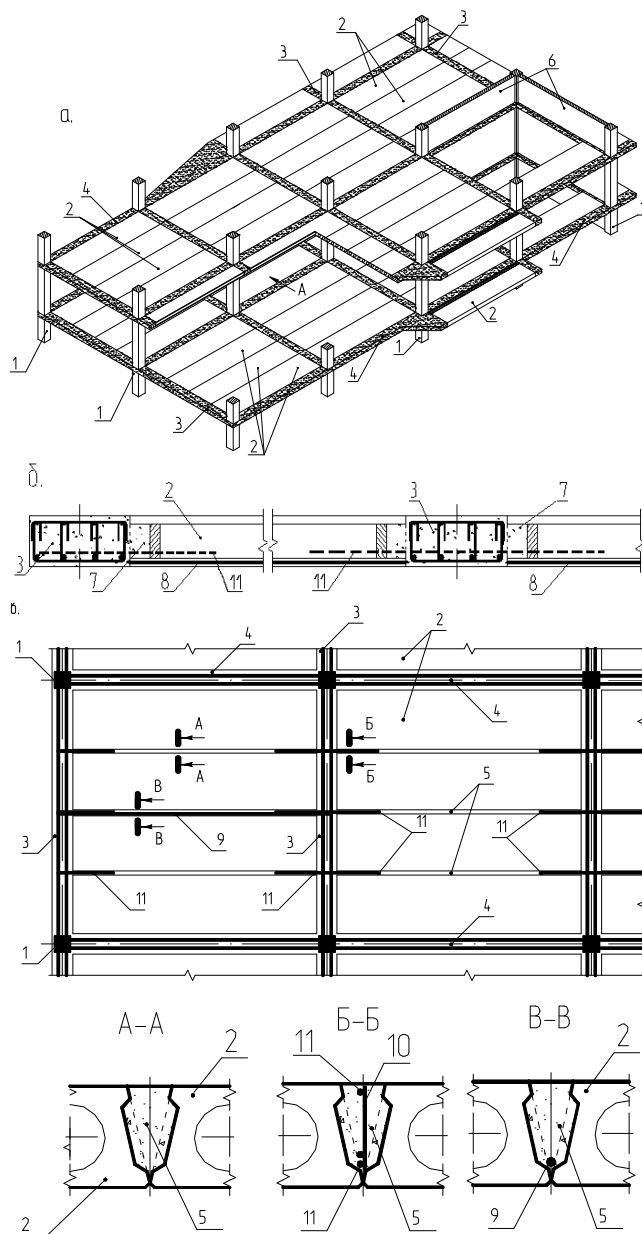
Конструкция каркаса. а – общий вид каркаса; б – сечение перекрытия, вид по стрелке А, в – фрагмент плана перекрытия; г – сечения межплитных швов.
